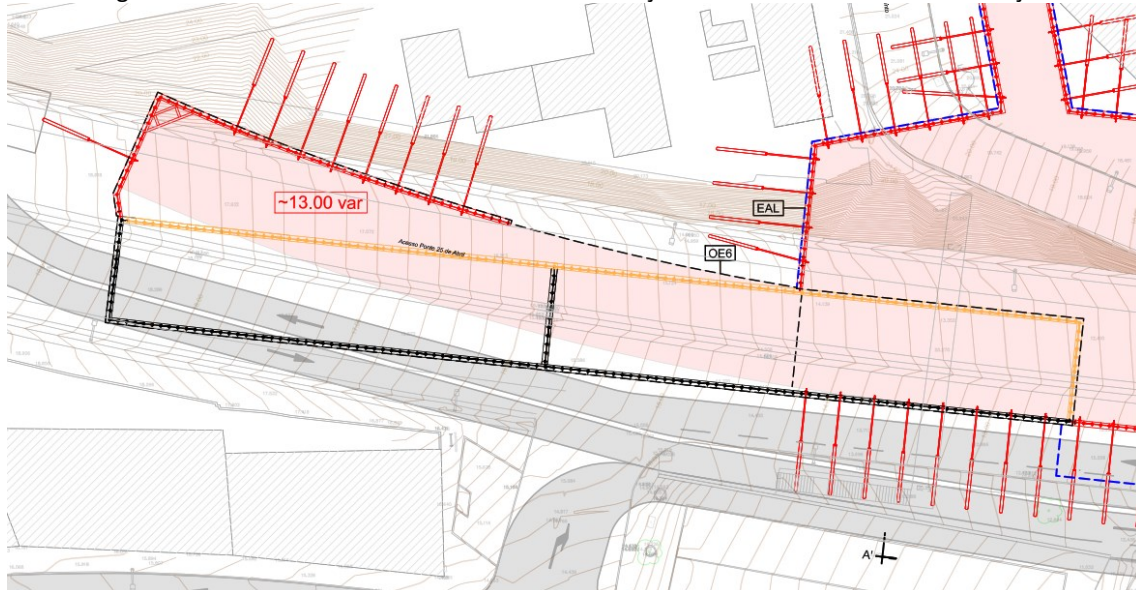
Planta de Dimensionamento Contenção Provisória – 3ª Fase de escavação
